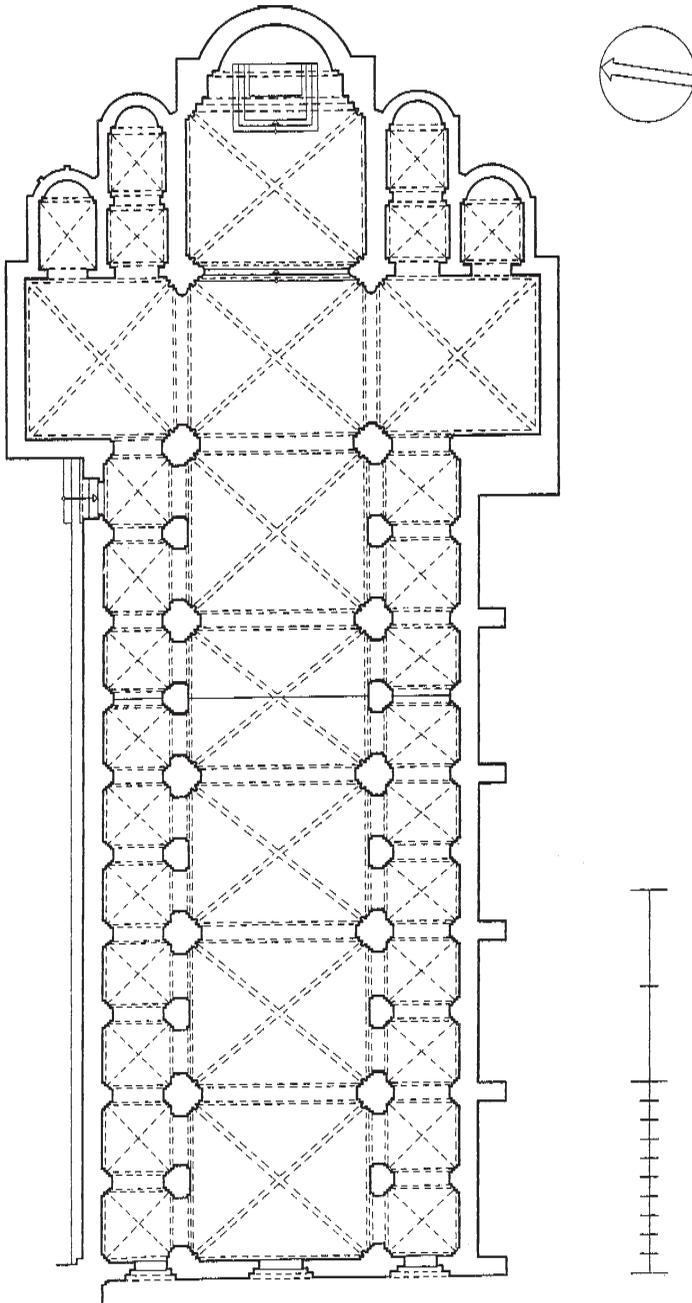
Alzella, Zisterzienser-Klosterkirche, Grundrissrekonstruktion, M 1:400
